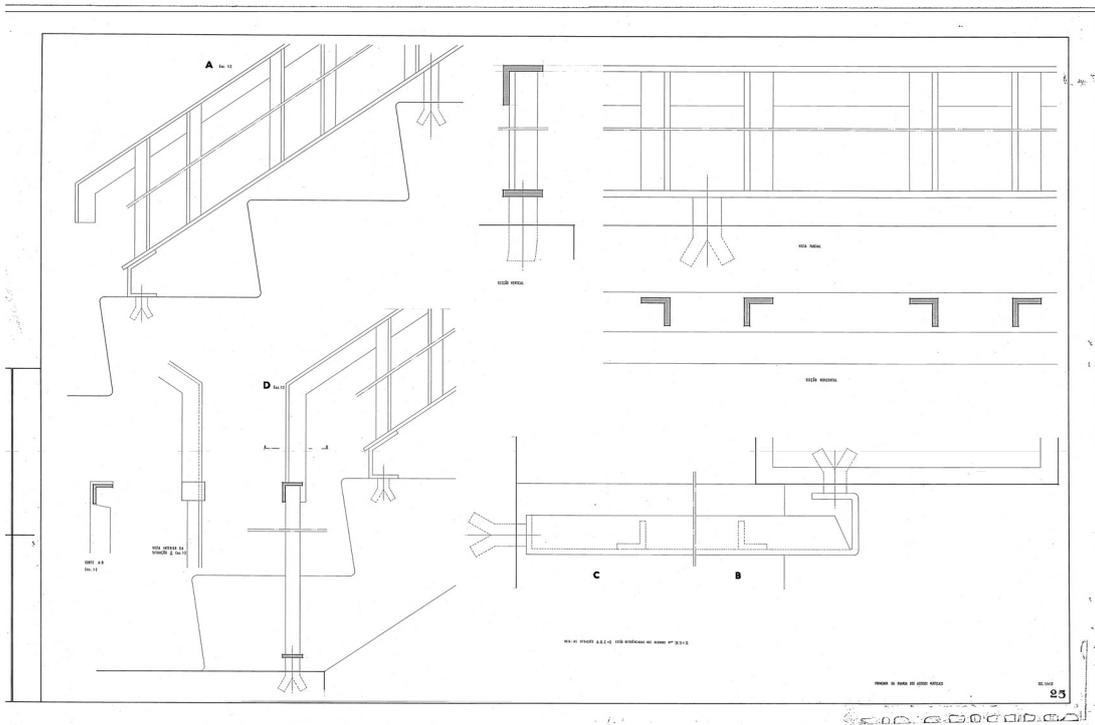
Projeto: pormenor da guarda dos acessos verticais
